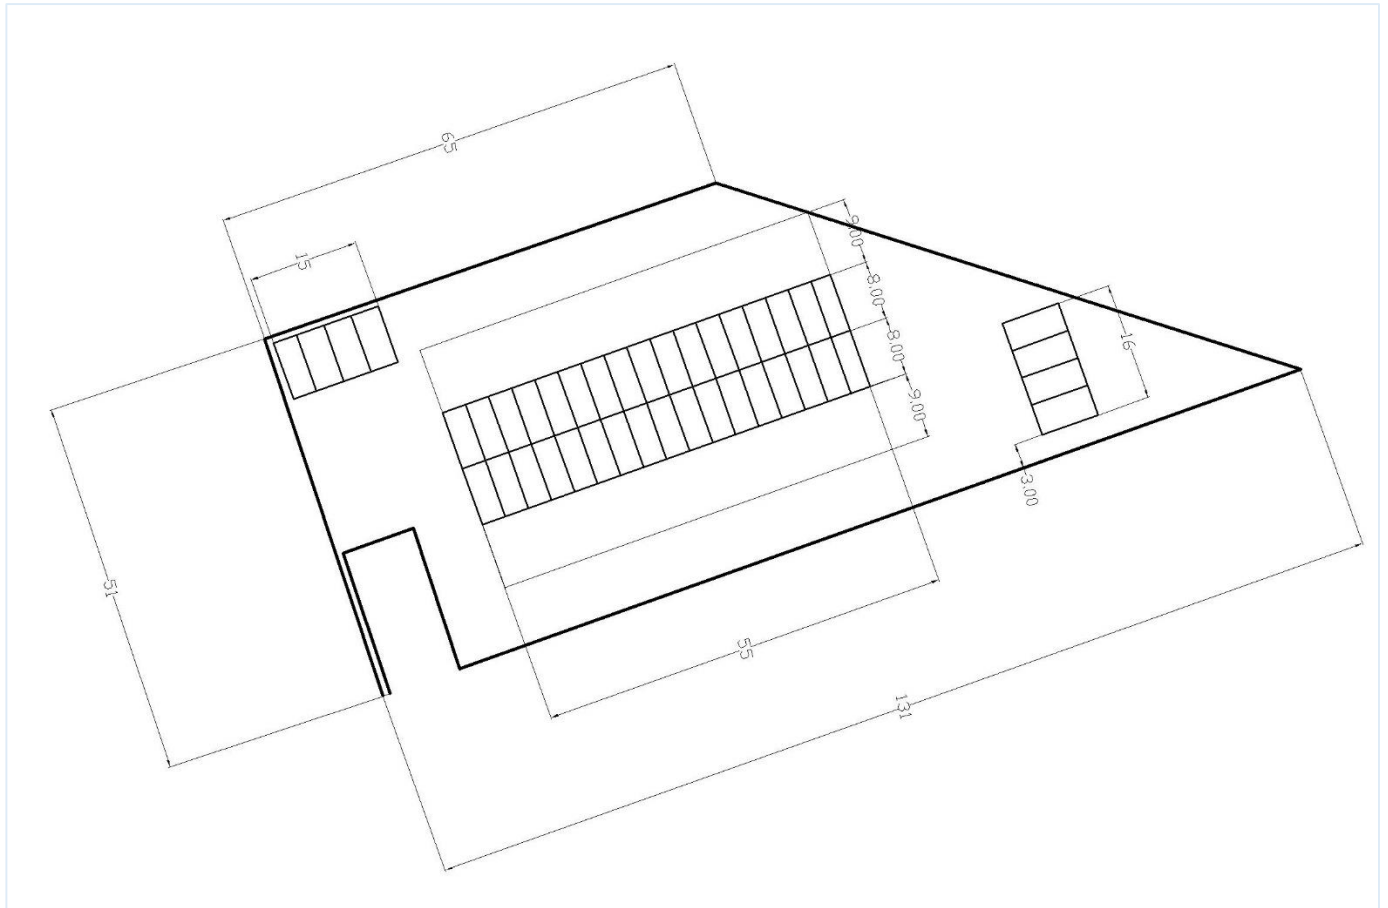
Detalle de la Alternativa 1 para la Marina Seca. Fuente: Elaboración propia.
